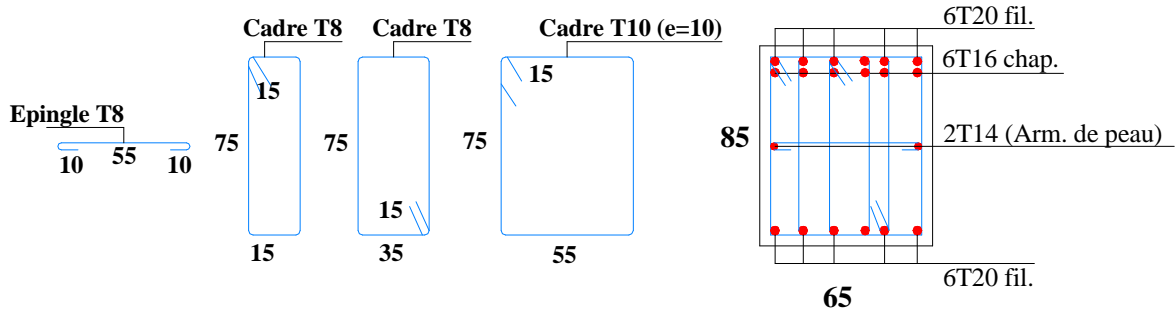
détails de ferrailage d'une travée de nervure.
